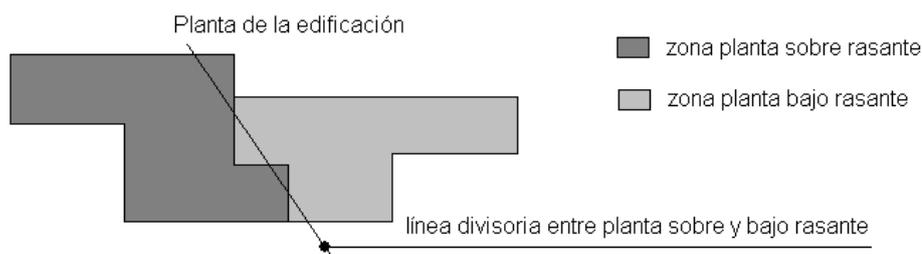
Reparto superficial equivalente siguiendo divisorias características de la edificación entre la zona considerada planta sobre rasante y planta bajo rasante.
